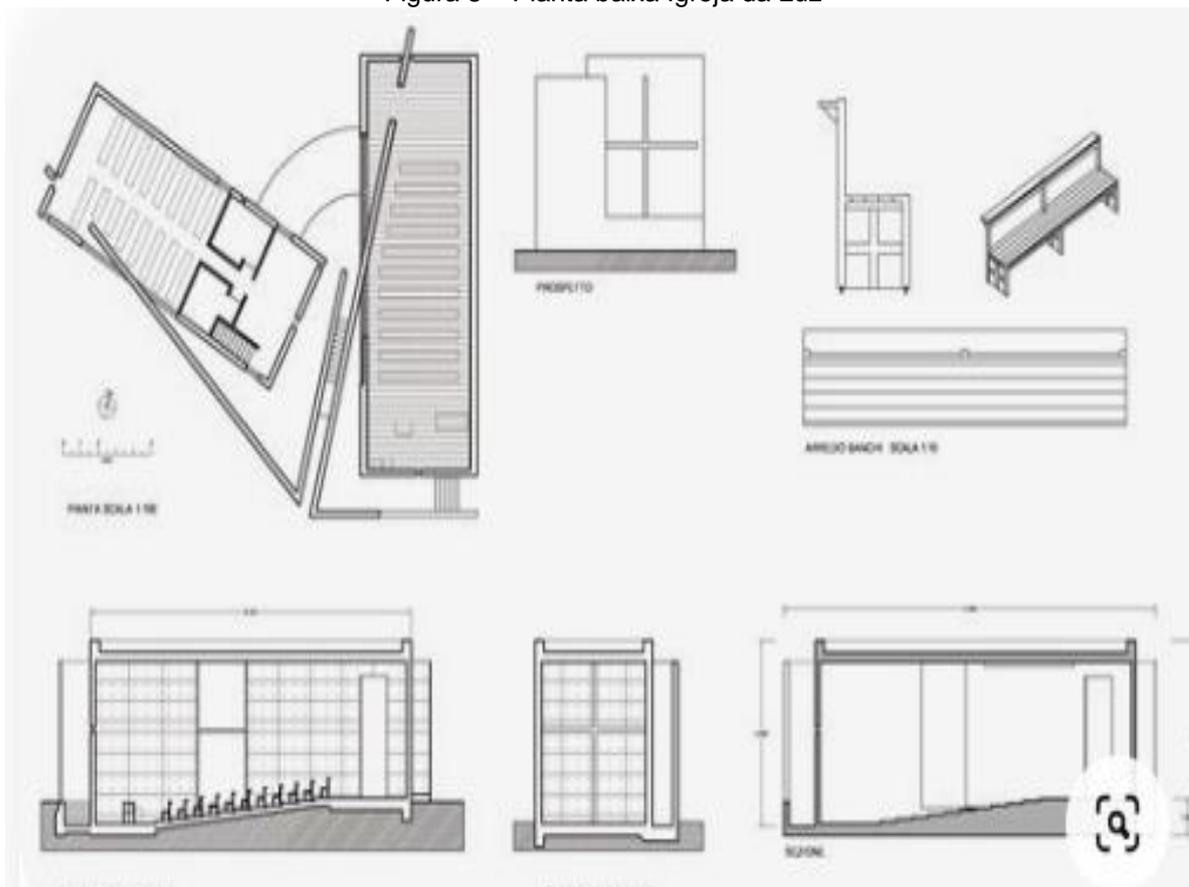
Vista do plano superior e cortes de concreto da Igreja
